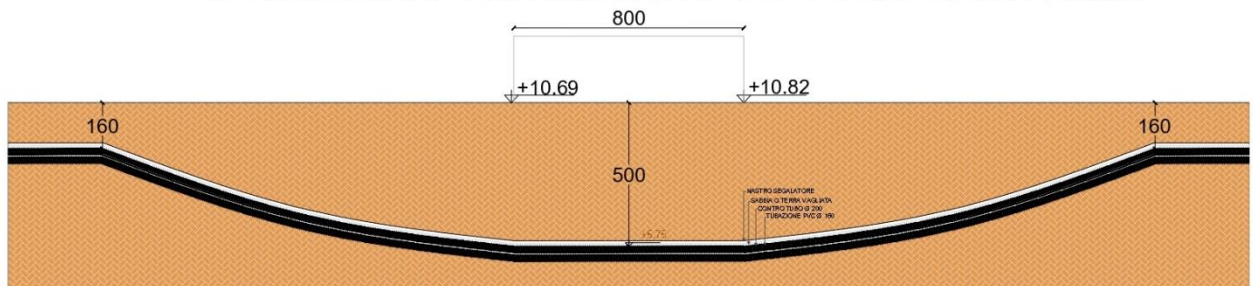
Tratto D-D' - Sezione attraversamento proprietà privata
